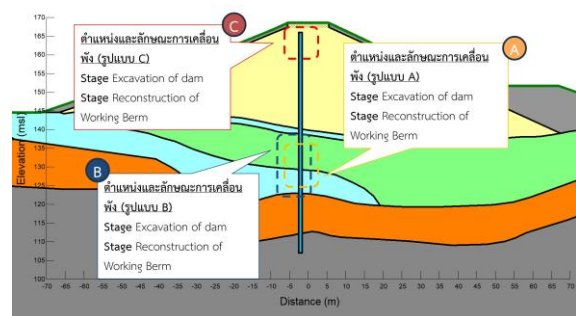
ขั้นตอนการก่อสร้าง (Staged Construction)
